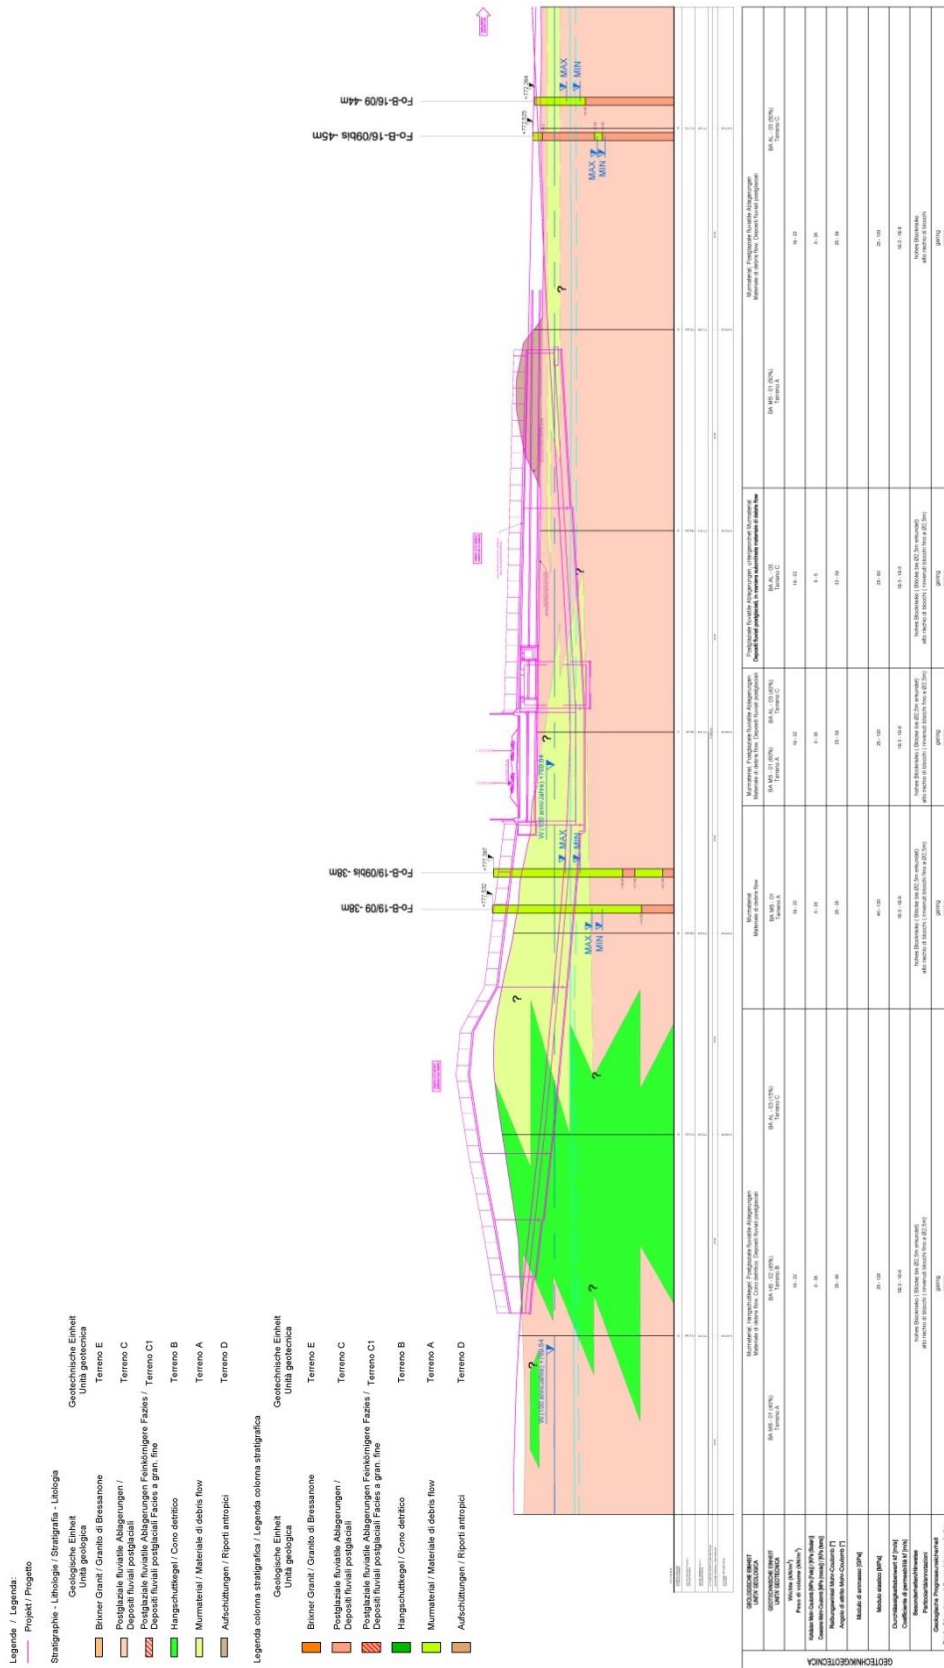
Geotechnisches Profil Eisenbahnunterführung.
